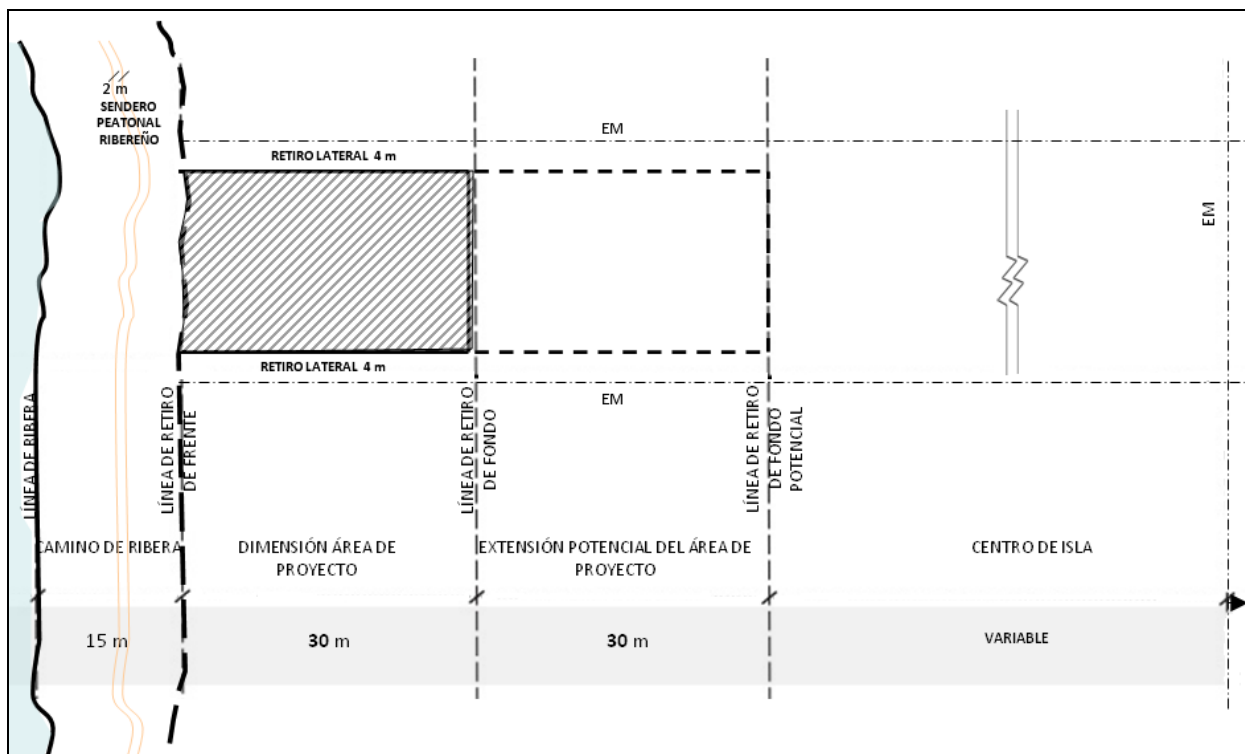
Croquis de ocupación de la parcela. Planta
